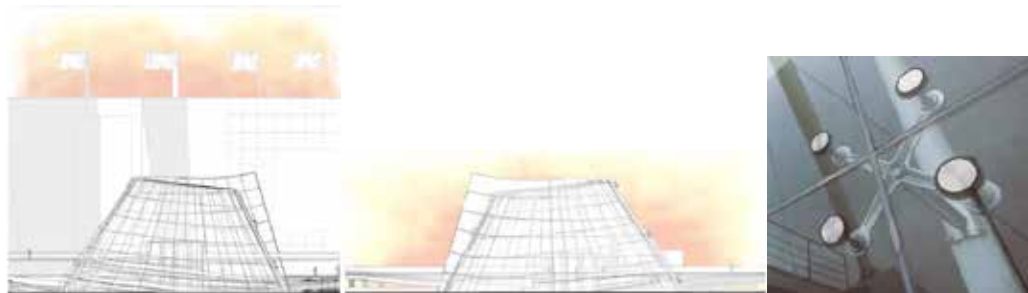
Fachadas frontal y posterior. Detalle de vidrio abotonado con estructura tipo araña.
